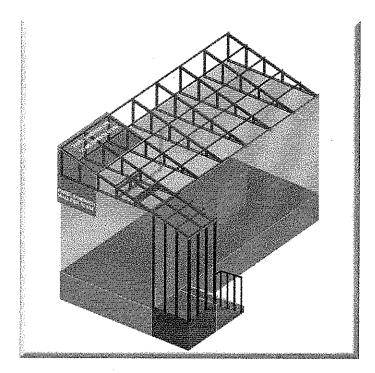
Isométrica alternativa de estructura de cubierta y baranda.
